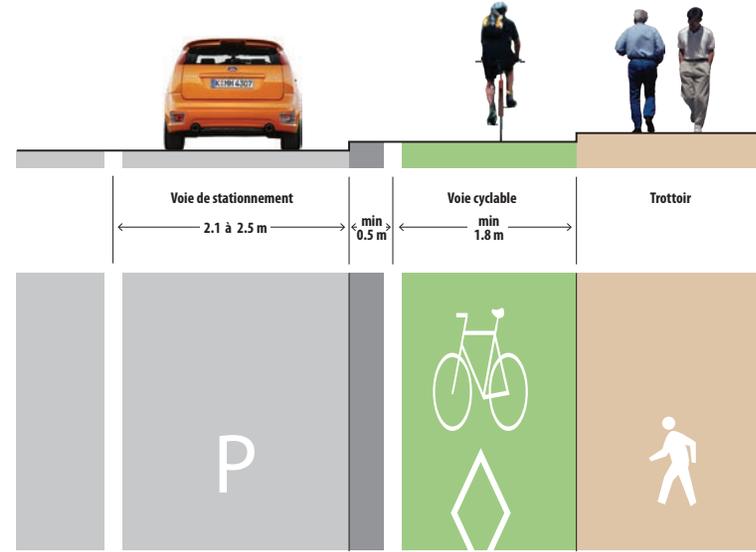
Installation unidirectionnelle séparée verticalement avec stationnement
